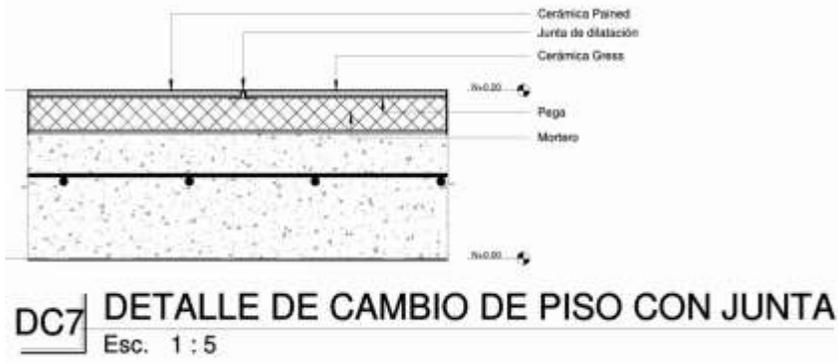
Detalle constructivo de junta de dilatación en cambio de piso. Elaboración propia
